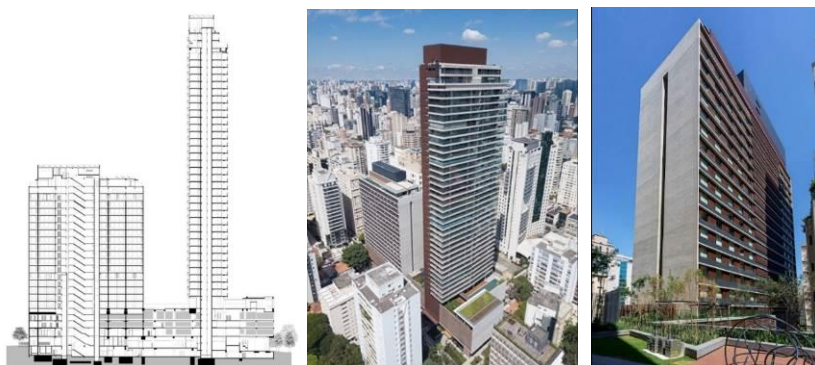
Fachadas do Complexo Fasano Itaim (Fonte: [www.even.com.br](http://www.even.com.br))
